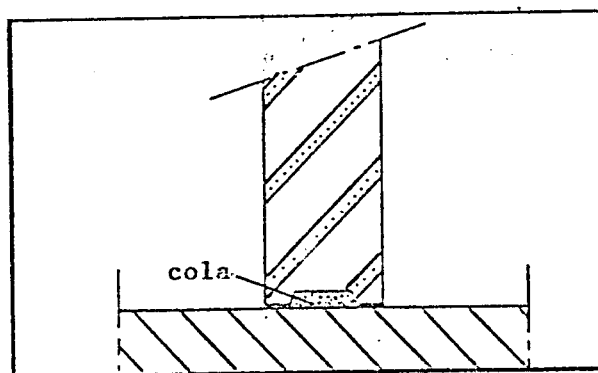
Pormenor de ligação da divisória amovível com o pavimento.
